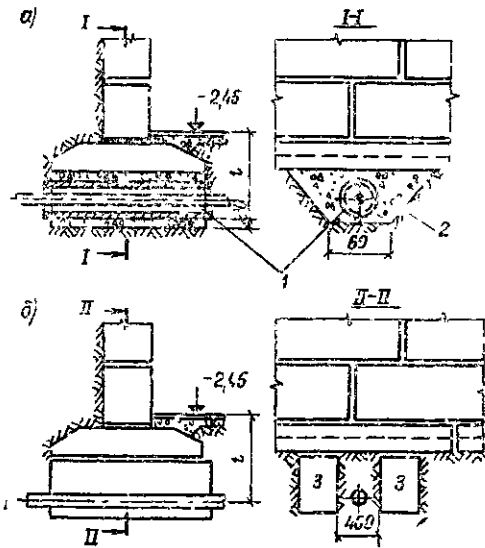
Пересечение вводов и выпусков с фундаментами из сборного железобетона
